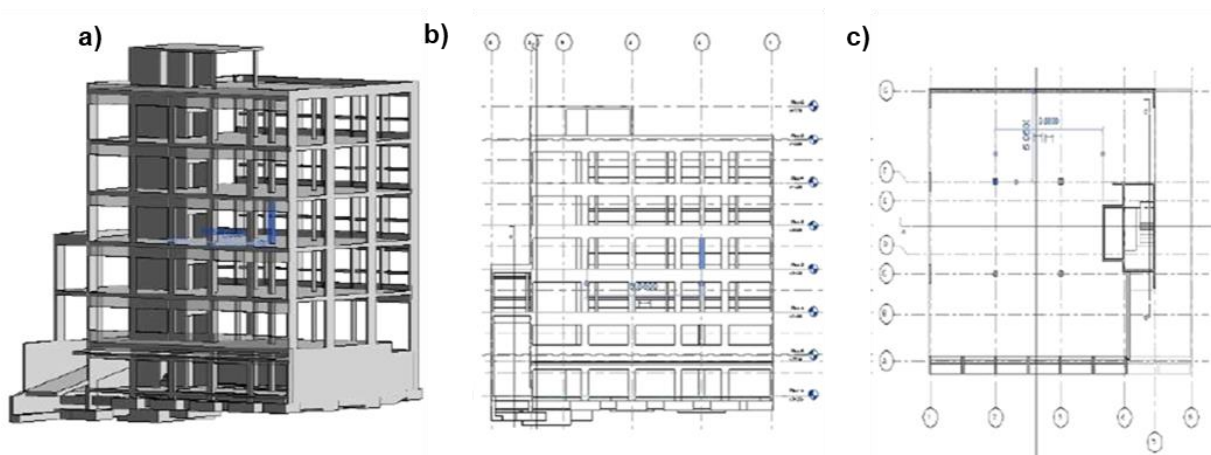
Demonstração da seleção simultânea em várias vistas de um objeto; a) Pilar selecionado em vista 3D; b) Pilar selecionado em vista de corte longitudinal; c) Pilar selecionado em vista de corte transversal;
